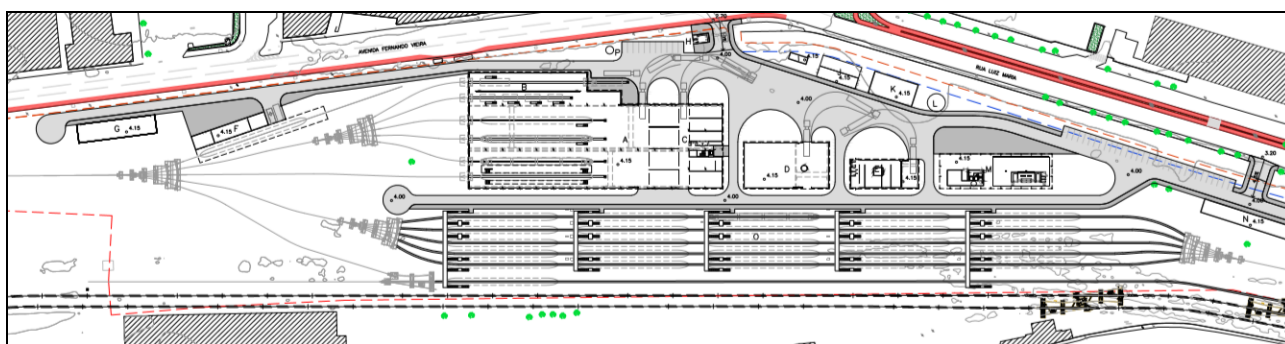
Planta Baixa do Pátio de Manutenção (Disponível para melhor visualização no ANEXO 2-2).
